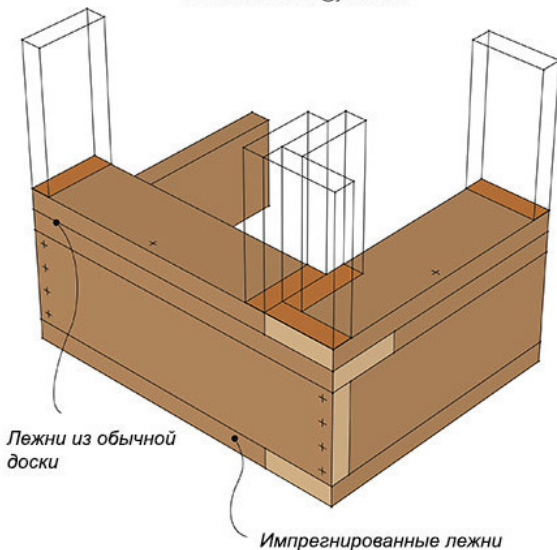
Принцип монтажа цокольного перекрытия по бетонной ленте фундамента
